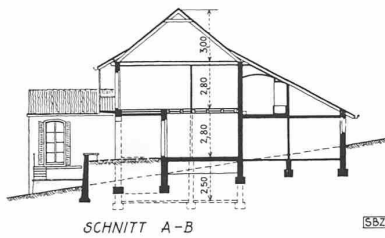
Schnitt 1:400 (vgl. Grundrisse S. 22/23)
